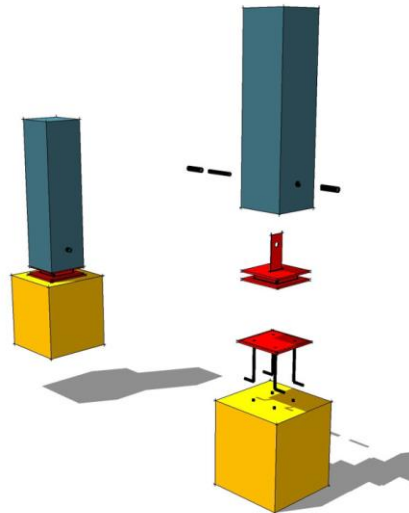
Exemplo de fixação de um pilar de madeira a uma fundação de betão e que pode ser adaptada ao projeto apresentado, Cochran (2014)
